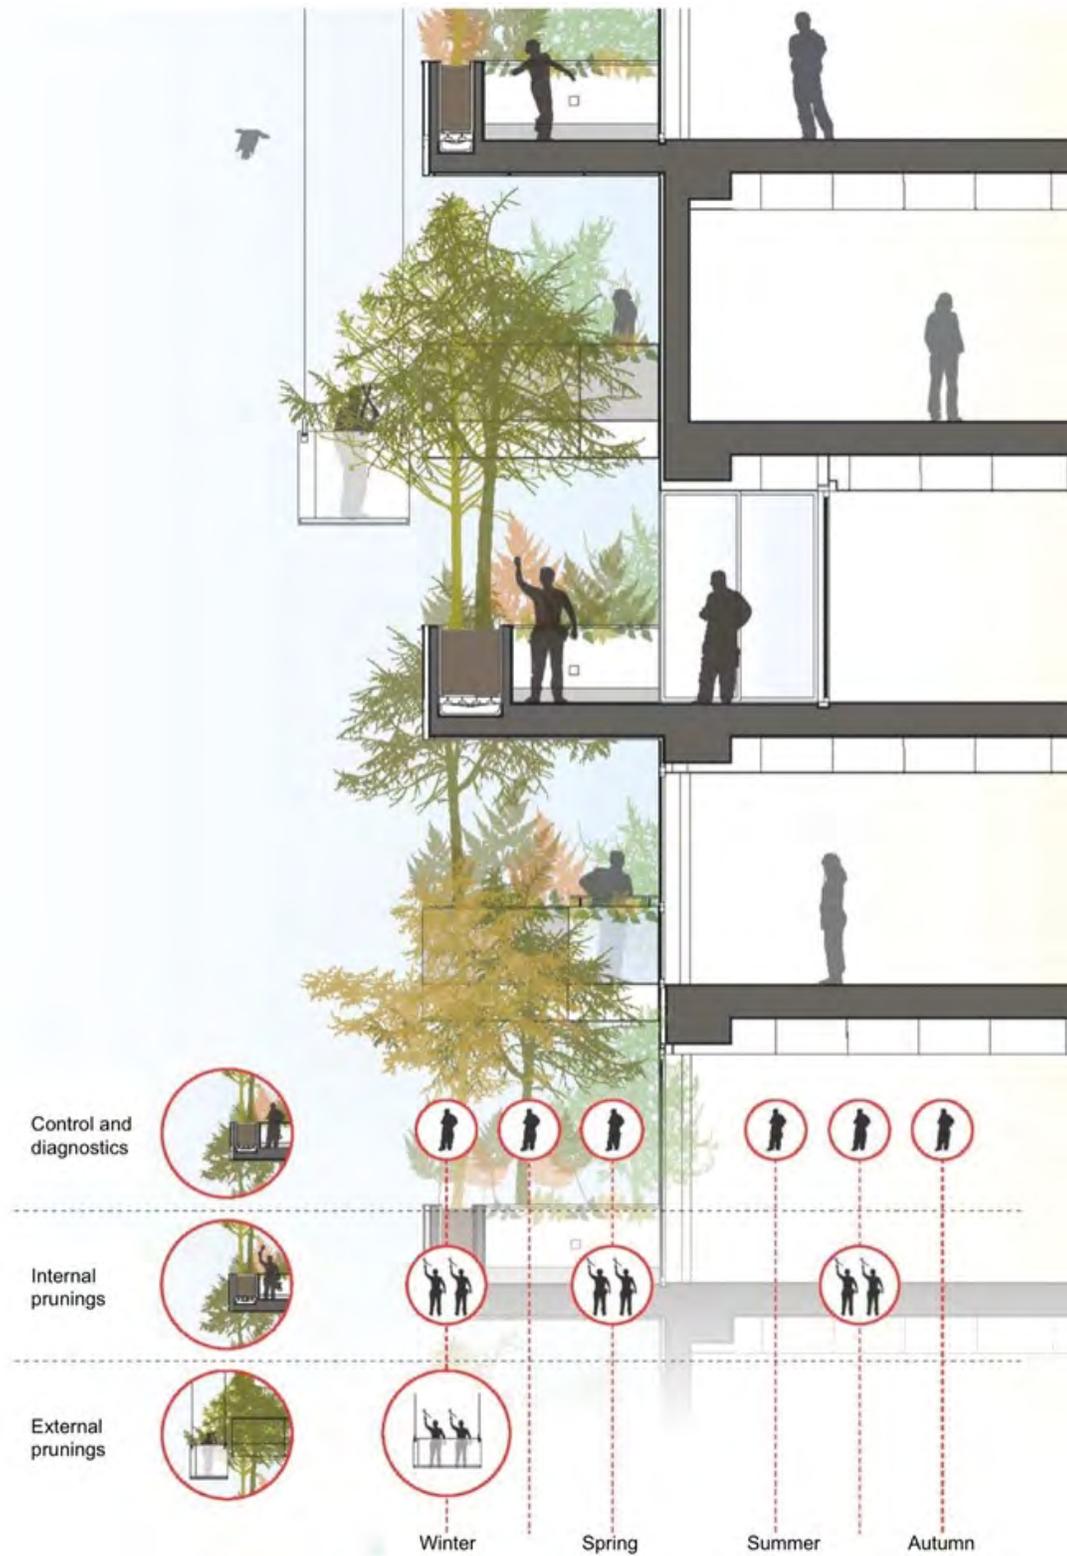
BOSCO VERTICALE/ Corte por Fachada
